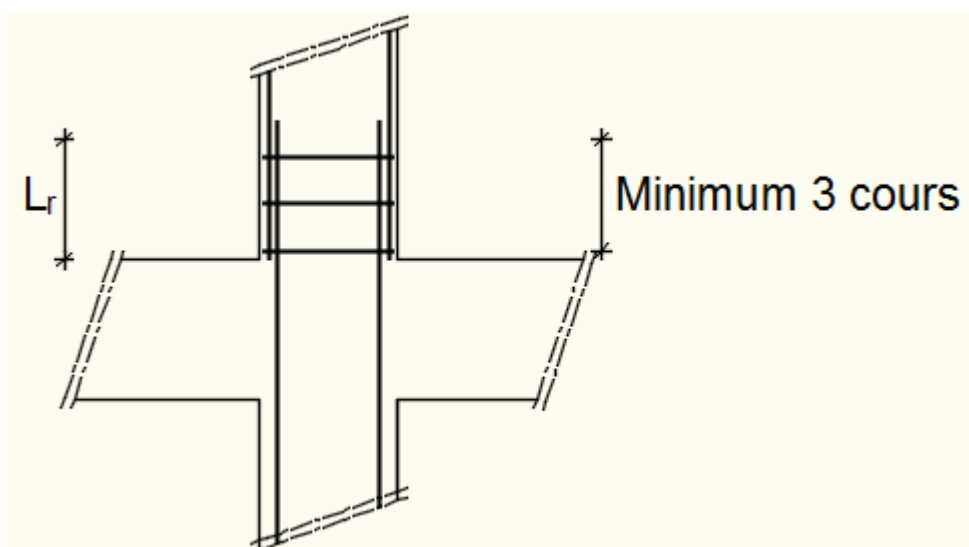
Armatures transversales dans la zone de recouvrement.
